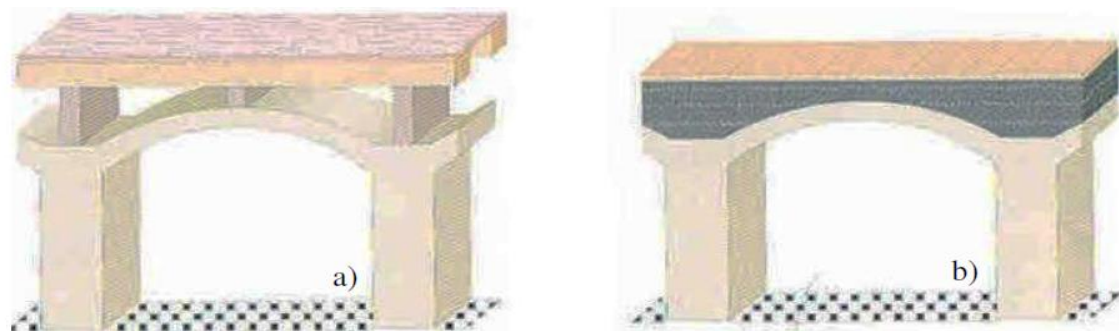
a) Pavimento assente em estrutura de madeira; b) Pavimento assente em arco preenchido com entulho; (Appleton, 2011).
